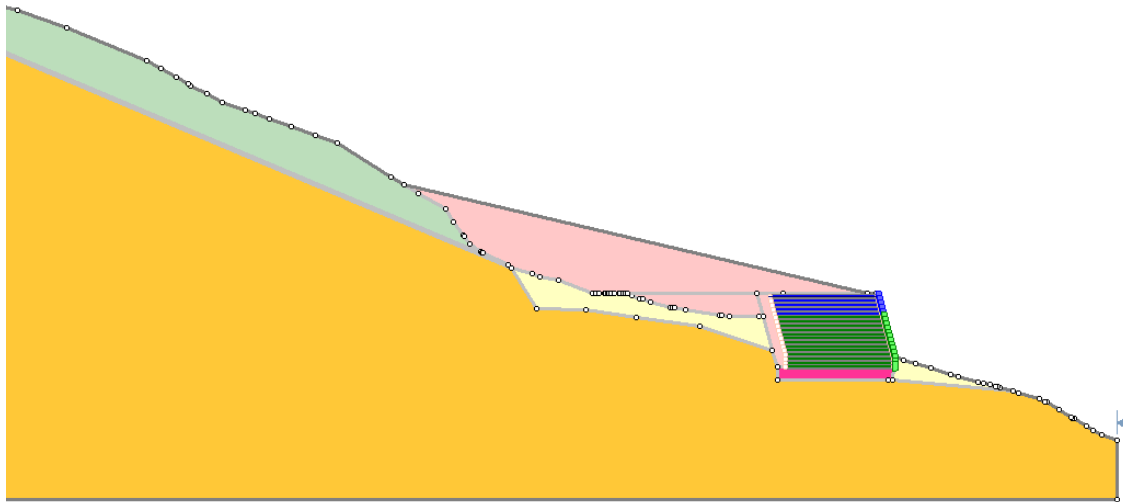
Modelo con muro en tierra armada perfil 6
